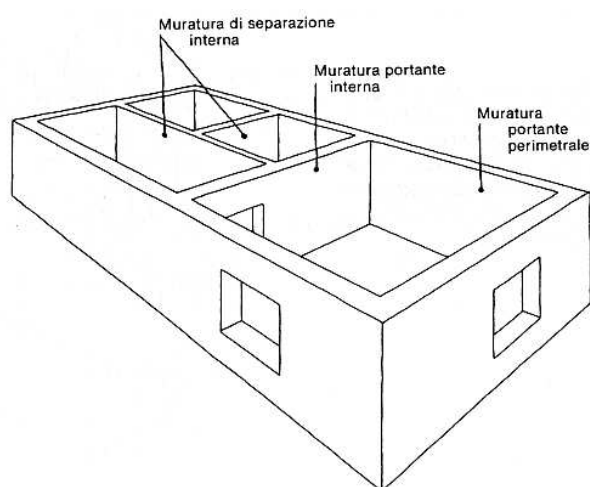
Esempi di muratura portante interna ed esterna
